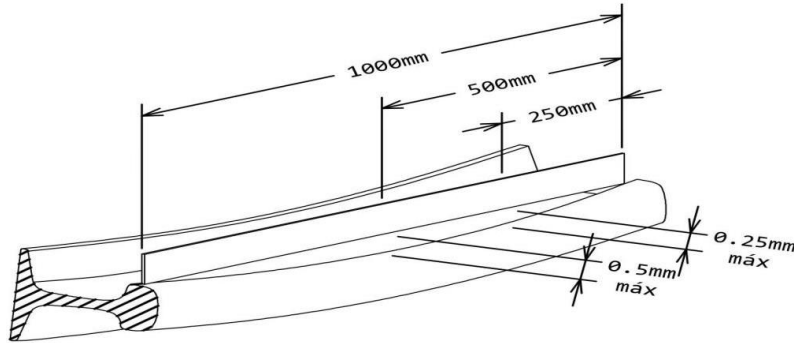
Tolerancia horizontal en extremos de rieles a soldar.
